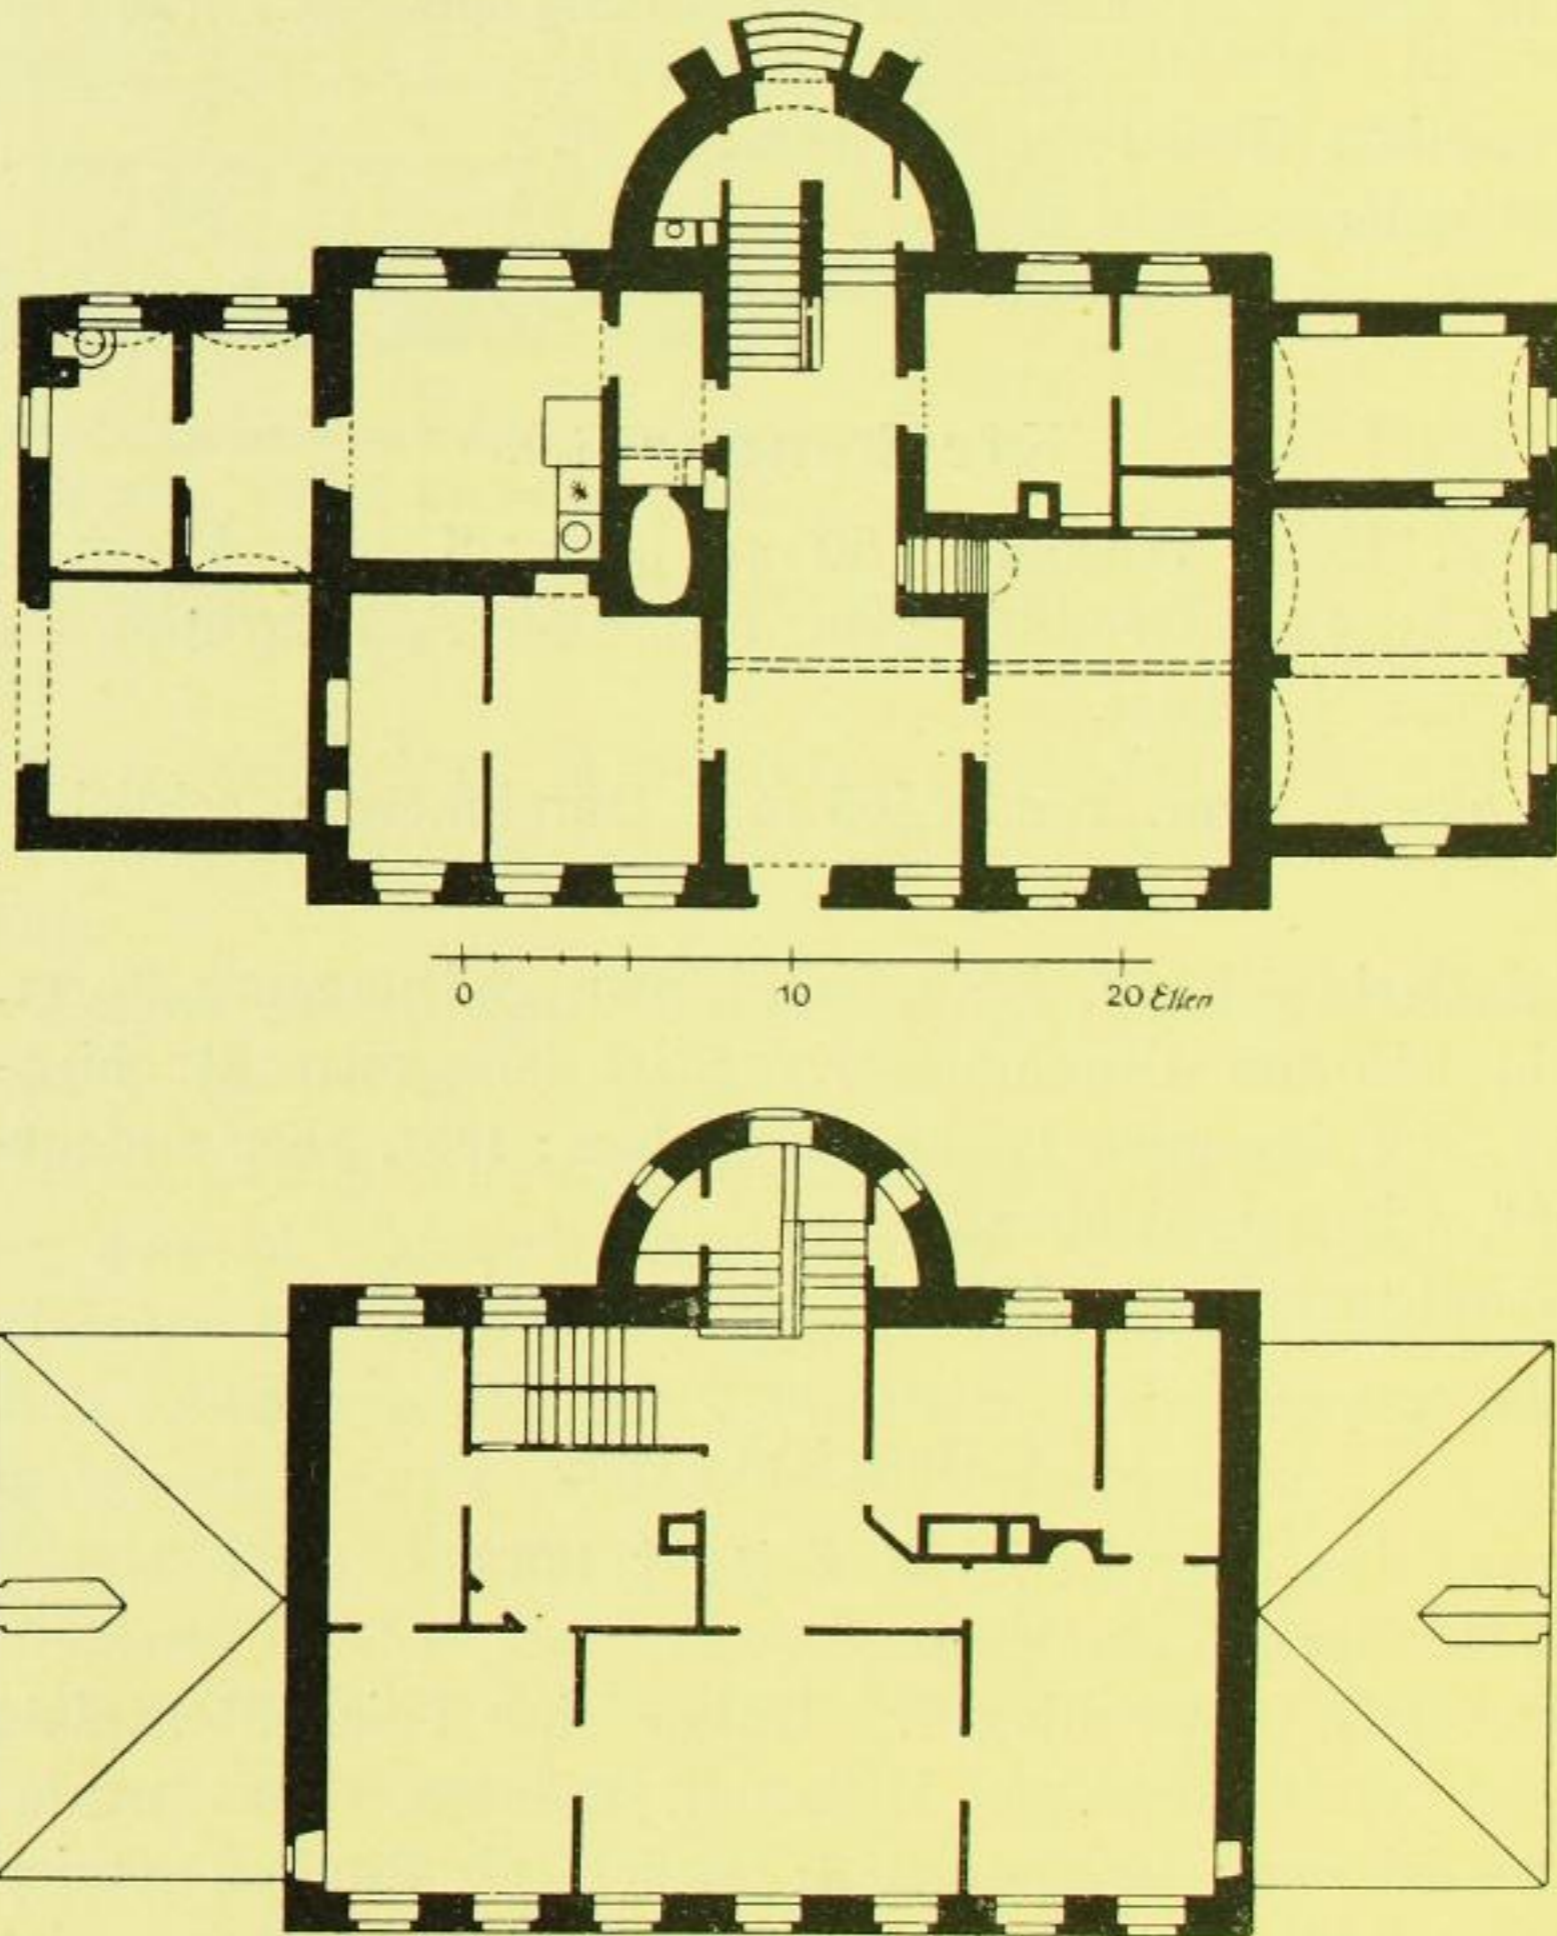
u. 520. Weißig, Forsthaus, Grundriß des Erd- und Obergeschosses.
